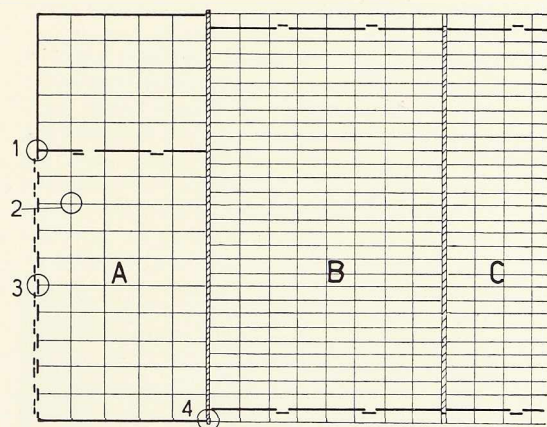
Vue en plan d'un hangar. Pour les détails 1 à 4, voir figure 3.
